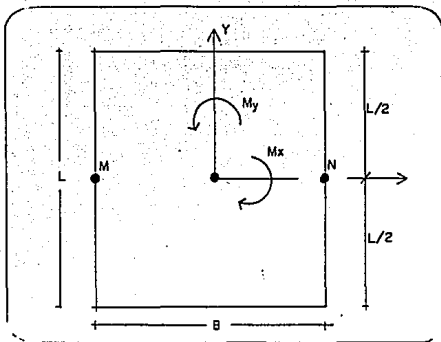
PLANTA DE CIMENTACION BAJO LA ACCION DE MOMENTOS Y CARGA VERTICAL.
